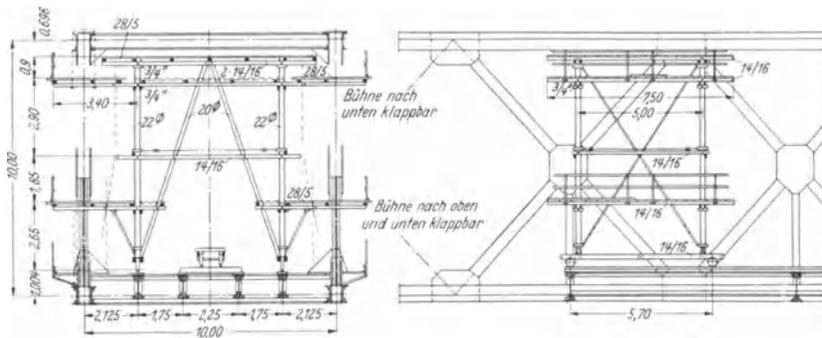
Fahrbares Nietgerüst beim Bau der Rheinbrücke Ludwigshafen-Mannheim.
